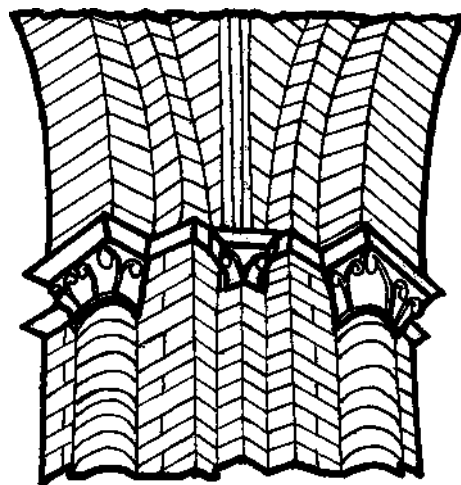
Engarjes de los apoyos con las cubiertas de la parroquia de San Nicolás.
